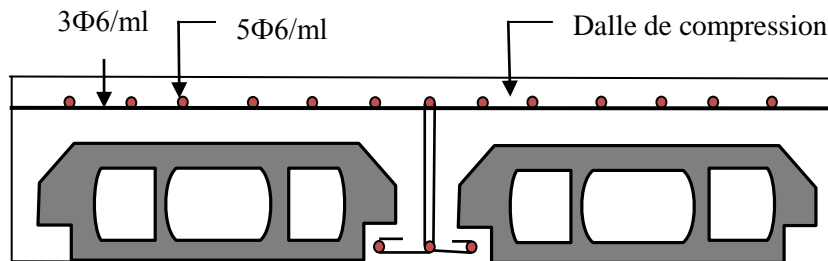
Schéma de ferrailage de la dalle de compression.
